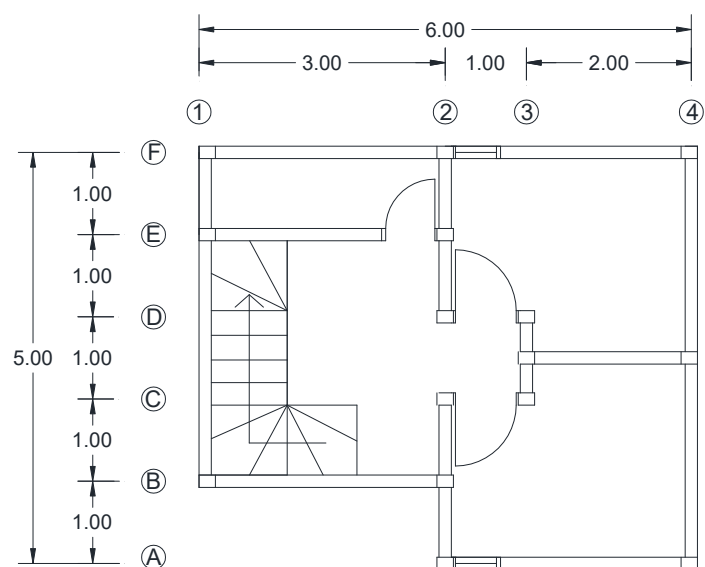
Denah rumah tinggal tipe 56 extension
